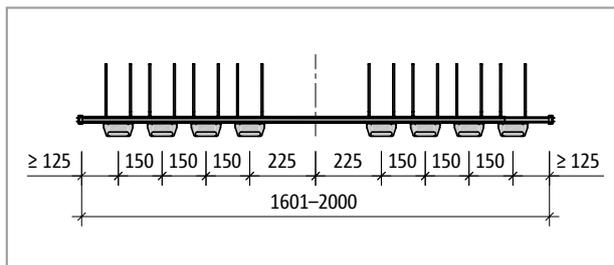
Schöck Tronsole® Typ T-V8-...-L1601 bis L2000: Produktgrundriss
